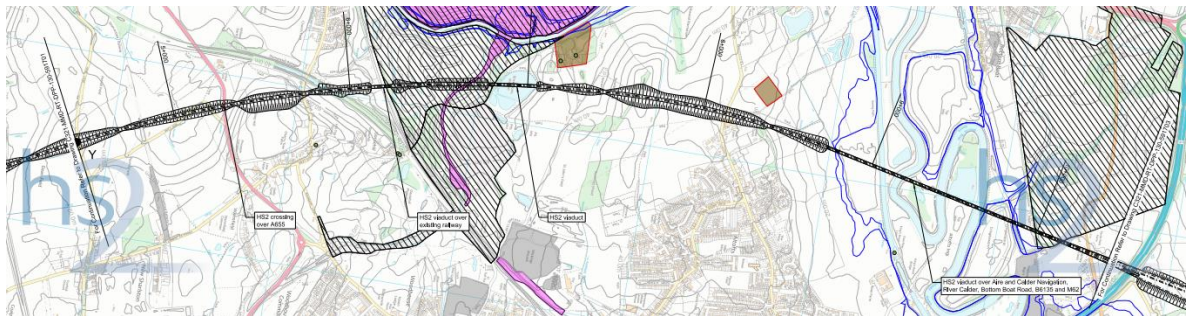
Planta do traçado viaduto sobre o canal de navegação Aire e Calder (Unido, HS2 Phase 2b: Charlston Common to Church Fenton route sheet 1).
